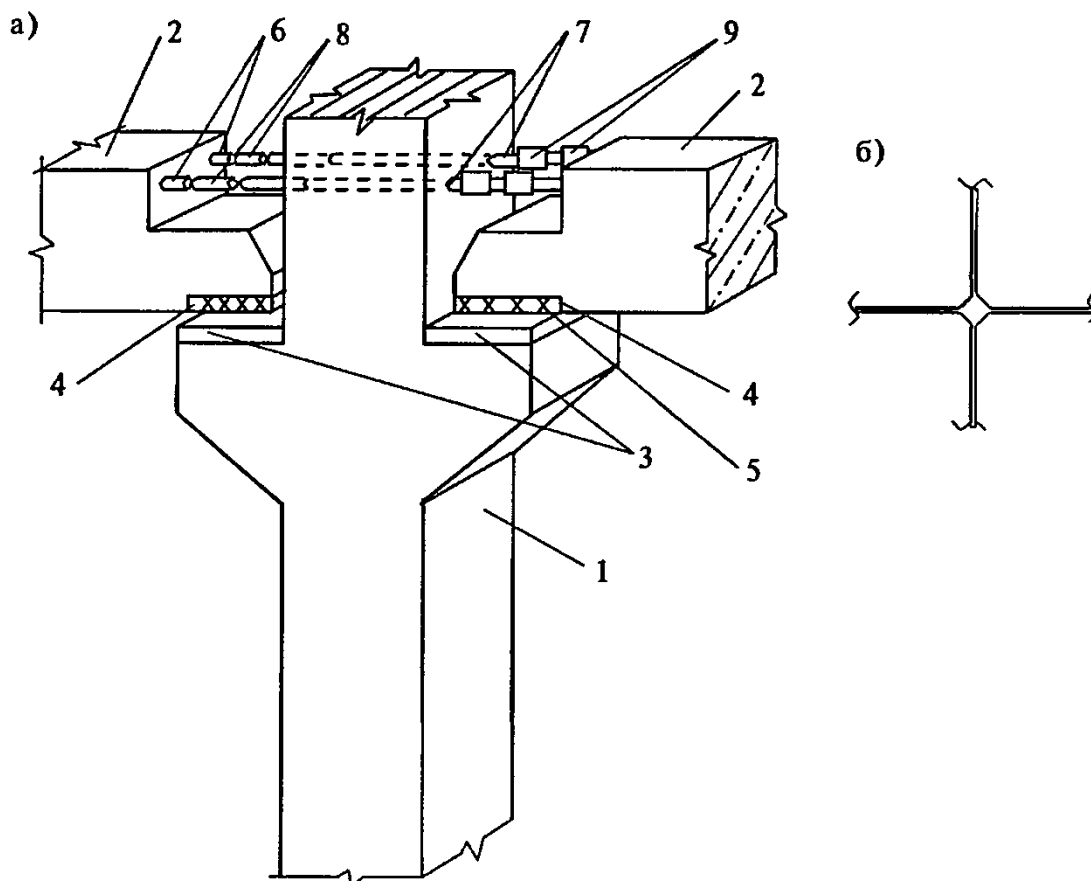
Жесткое соединение железобетонного ригеля с колонной:
